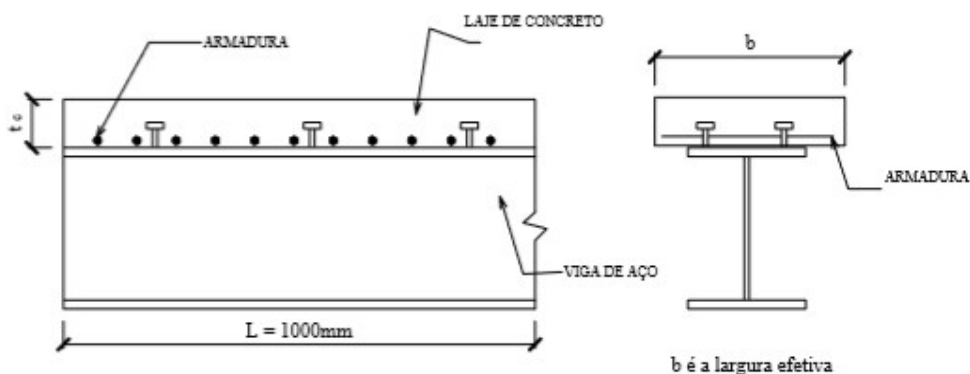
Disposição das armaduras transversais (adicionais) na laje de concreto (TRISTÃO, 2002).
